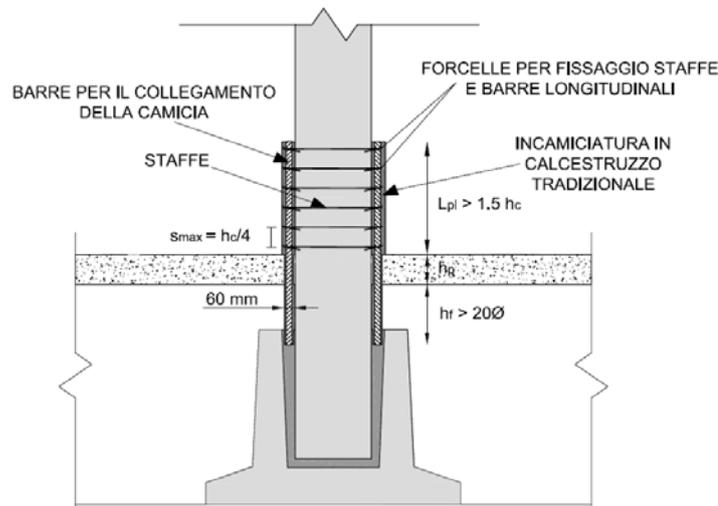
Incamiciatura in calcestruzzo tradizionale
